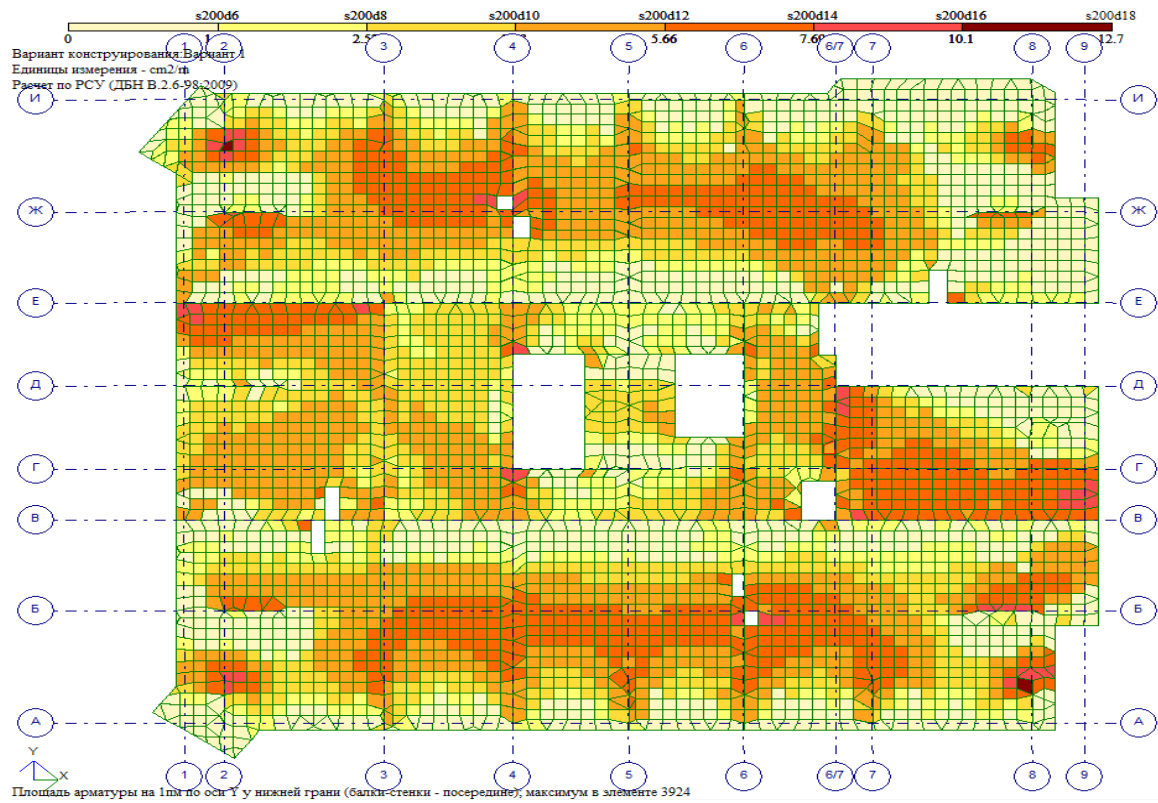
Перекрыття на відмітці 0.000 м. Нижня арматура по Y
